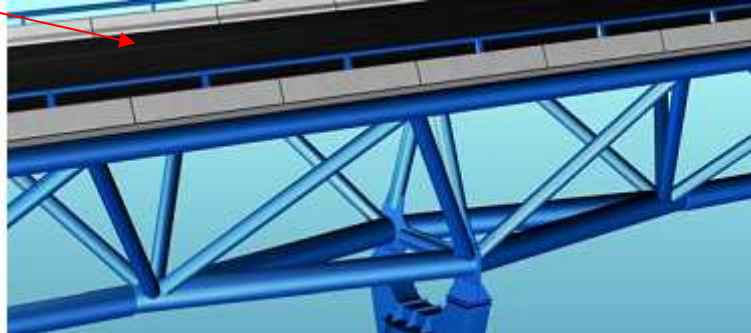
12 Puente tipo de Armadura de paso superior y tablero de hormigón
